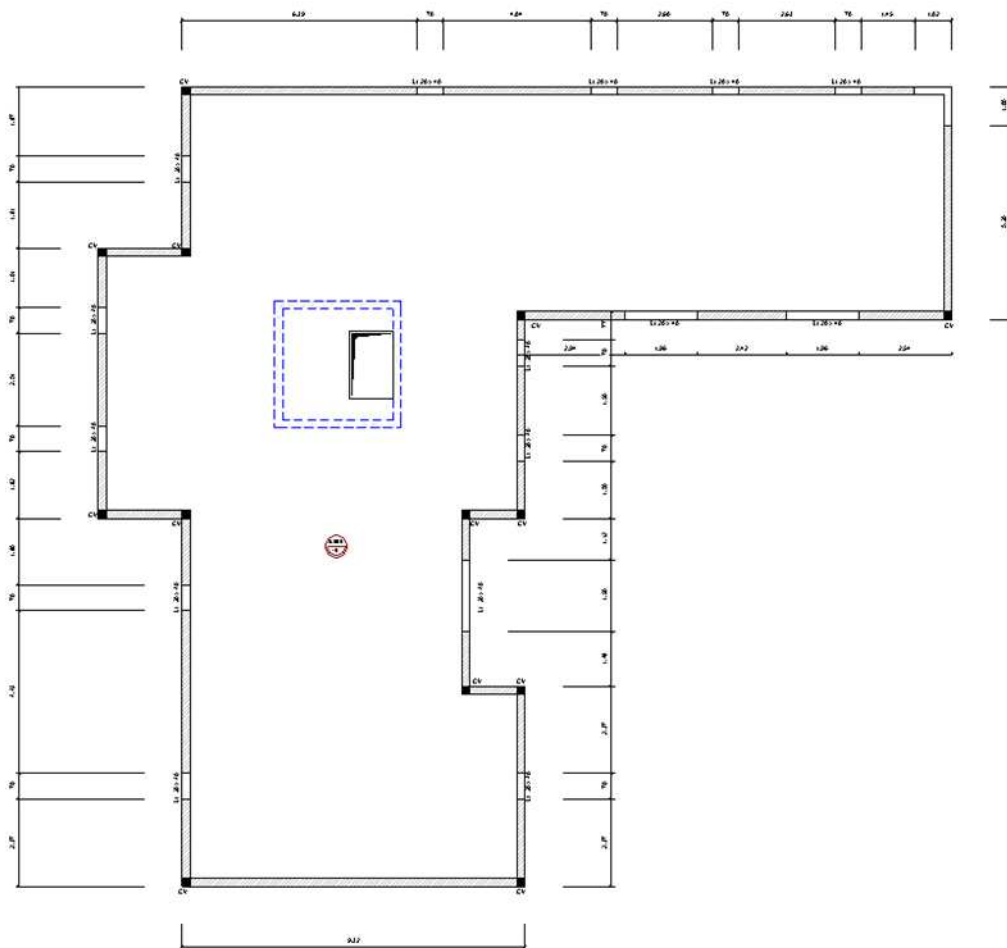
Plan de coffrage du plancher haut du niveau 1
